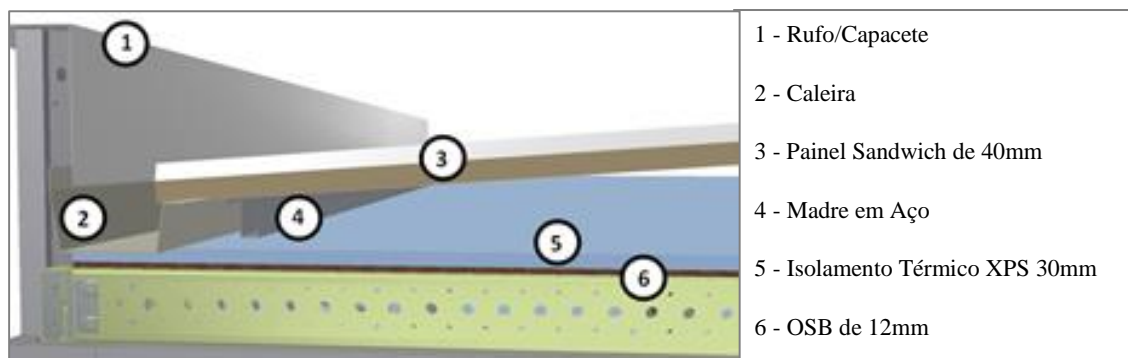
Cobertura inclinada com painel sandwich Teketo
